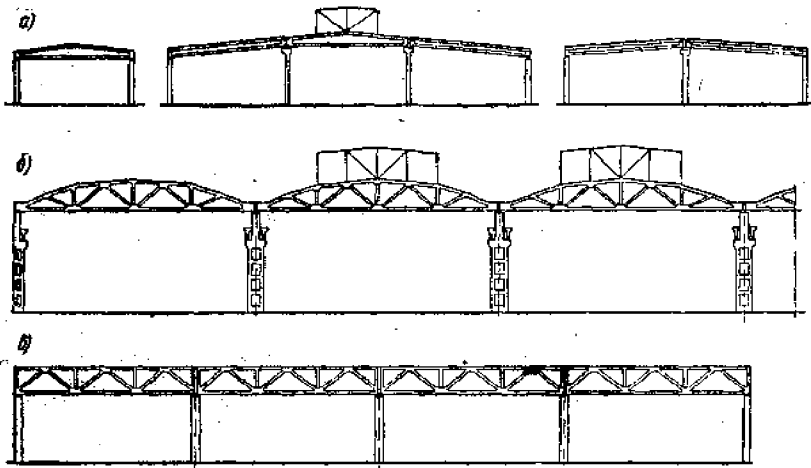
Одноэтажные многопролетные здания с типовыми железобетонными конструкциями: *а* – бескрановые одно-, двух- и трёхпролётные здания с применением двускатных и односкатных балок (с наружным отводом воды); *б* – здания, оборудованные мостовыми кранами, с применением ферм со скатной кровлей и внутренним отводом воды; *в* – бескрановые здания с плоской кровлей
